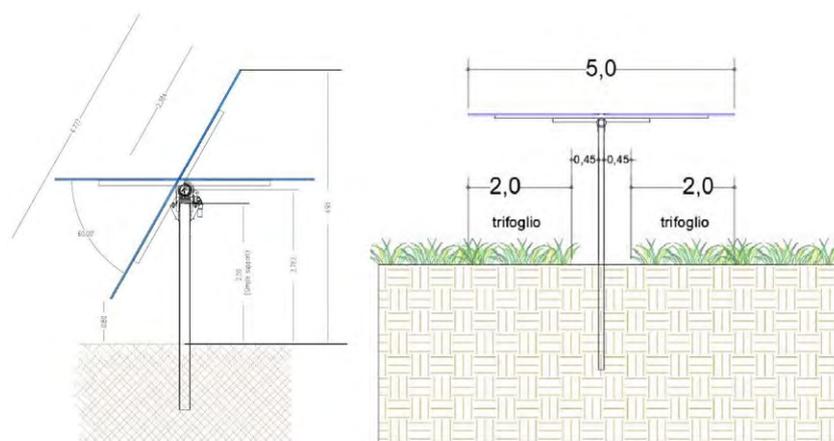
Sezione dell'area dell'impianto con indicazione delle scelte progettuali
